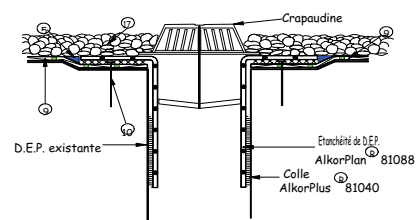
Etanchéité préfabriquée de descentes d'eau pluviales
